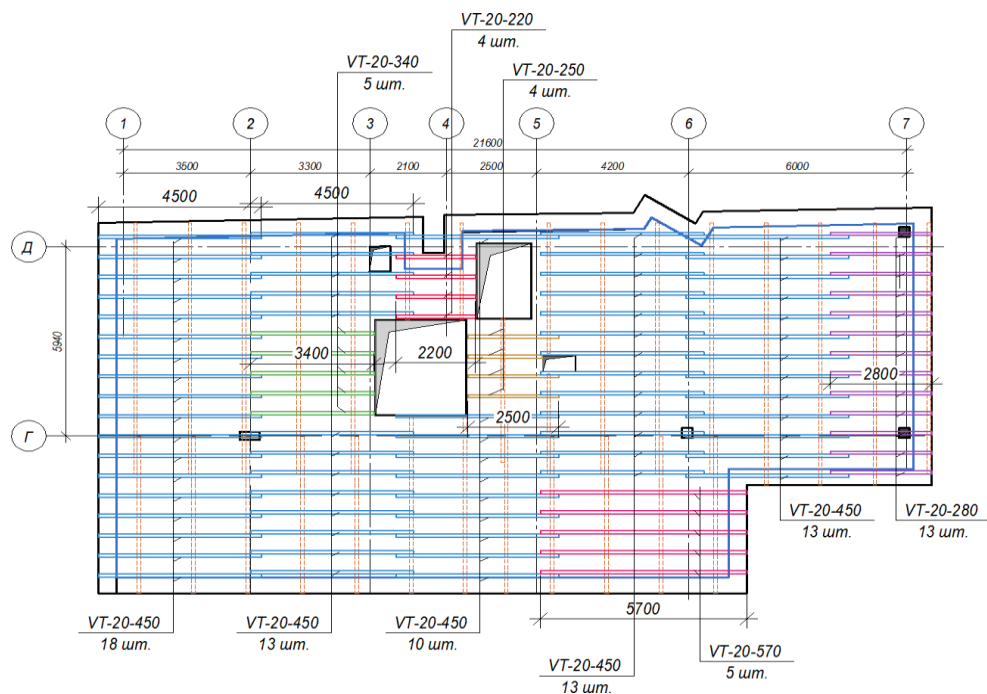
Схема розкладання елементів опалубки на рівні балок верхнього ярусу на першій захватці
